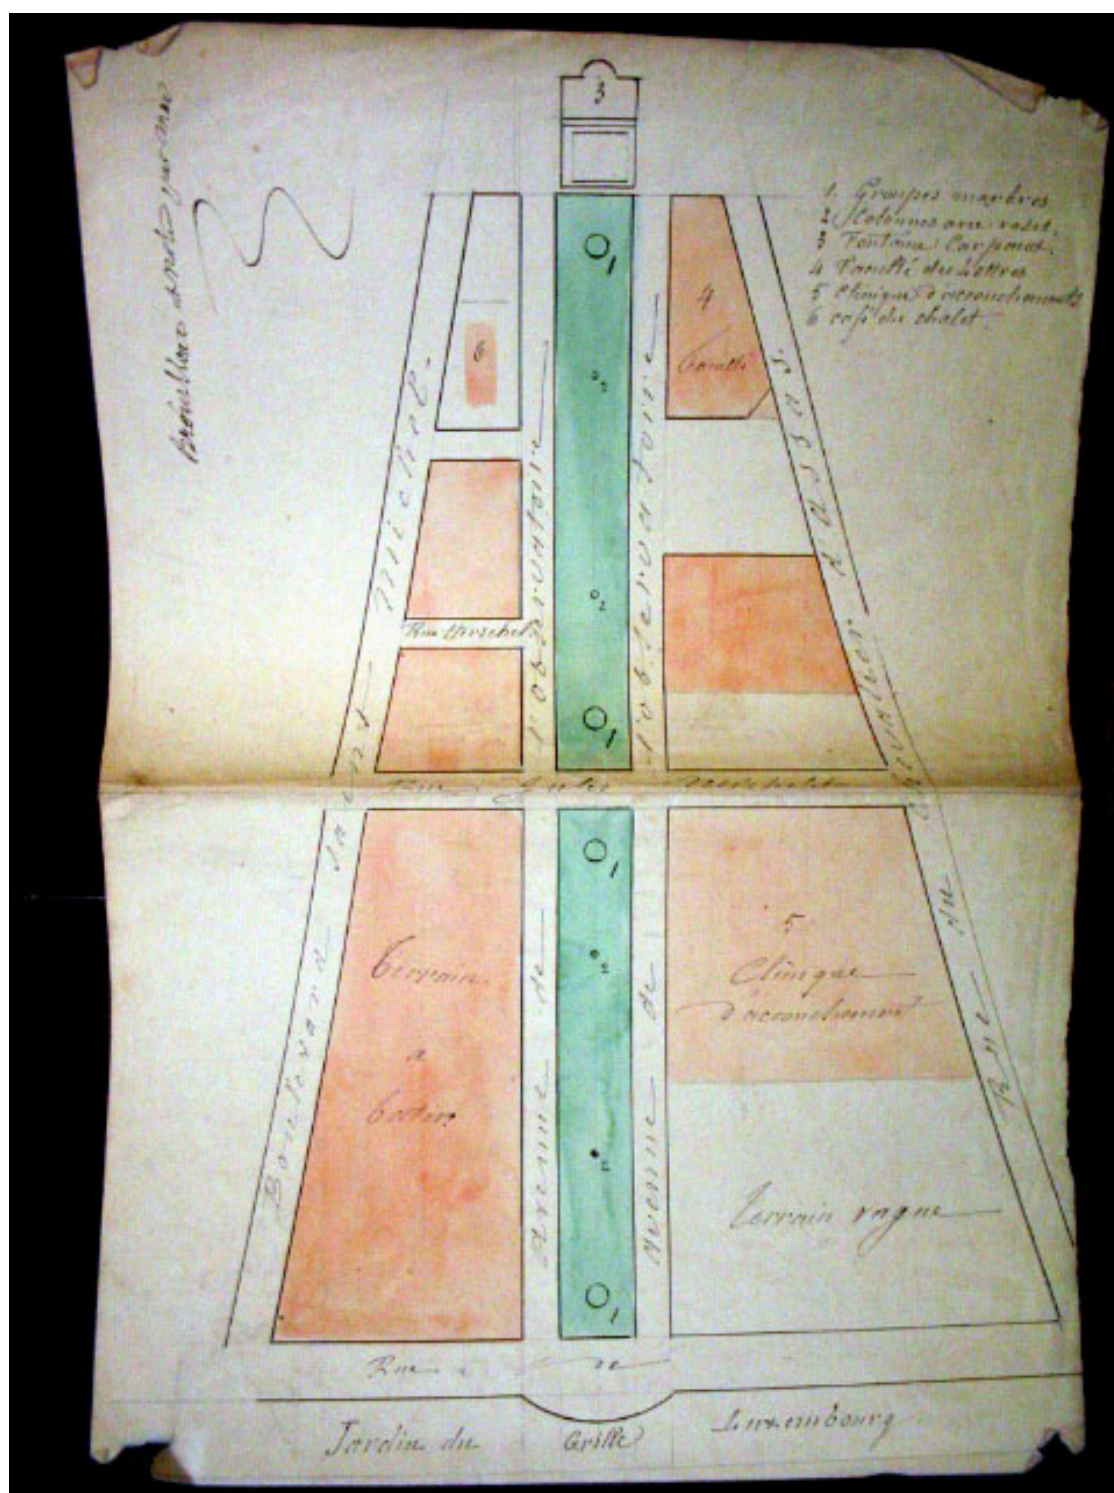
Anonyme, plan du secteur de l'avenue de l'Observatoire, vers 1880 (Arch. Mus. nat., 2HH4).
